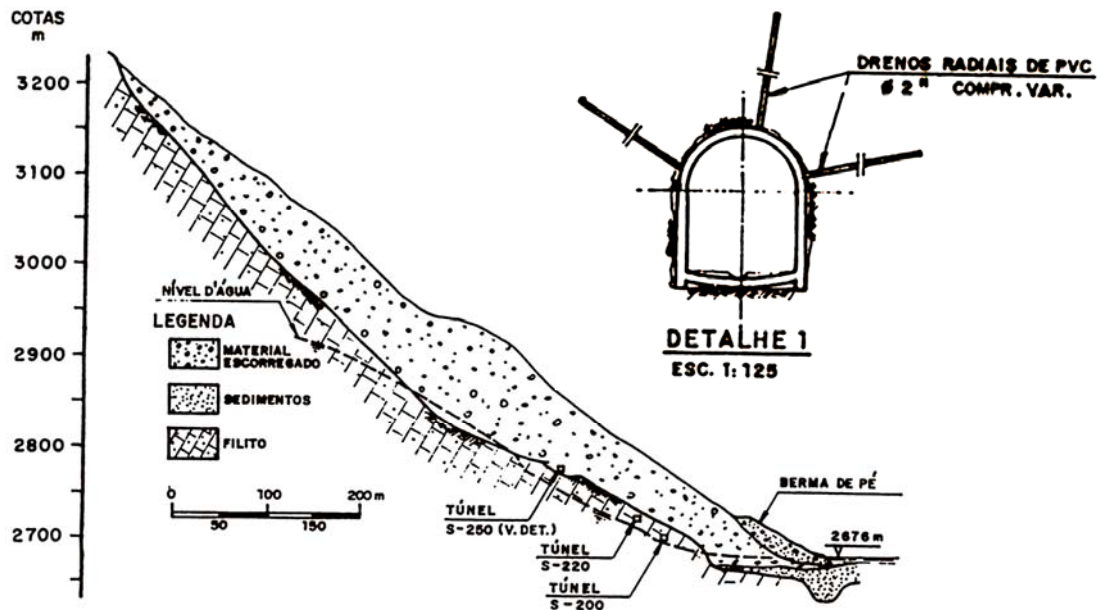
Corte II – Obras de estabilização do escorregamento junto à barragem de Tablachaca (Yassuda, 1988).
